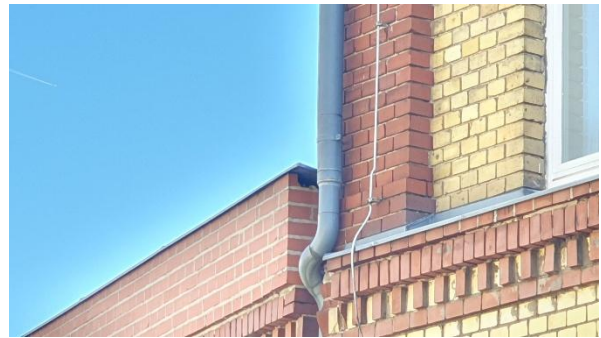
Öffnung im Mauerwerk an Dachkante
